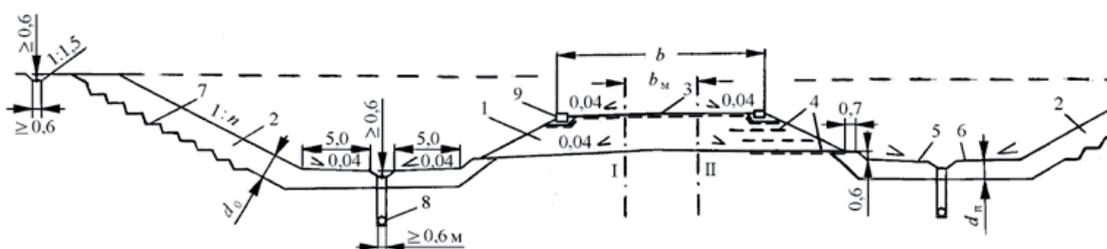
Поперечный профиль выемки глубиной до 4 м в глинистых грунтах при ее разработке под насыпь:
